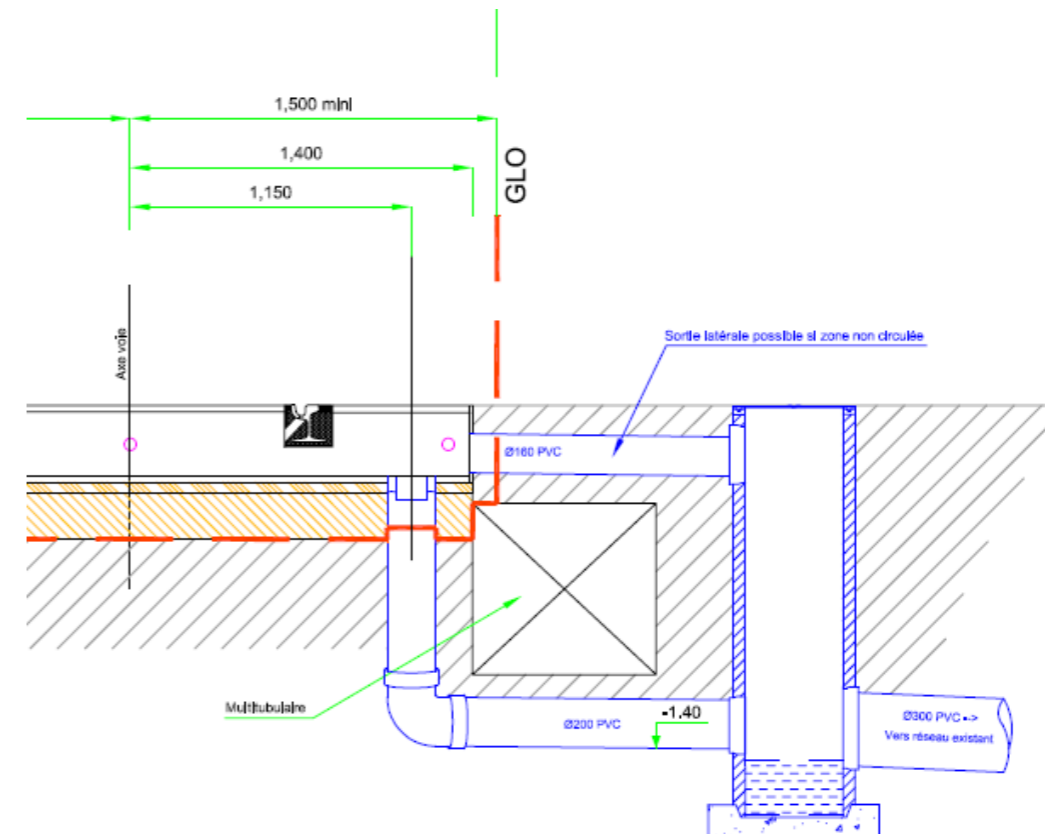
principe de raccordement au réseau public pour les voies sur béton
